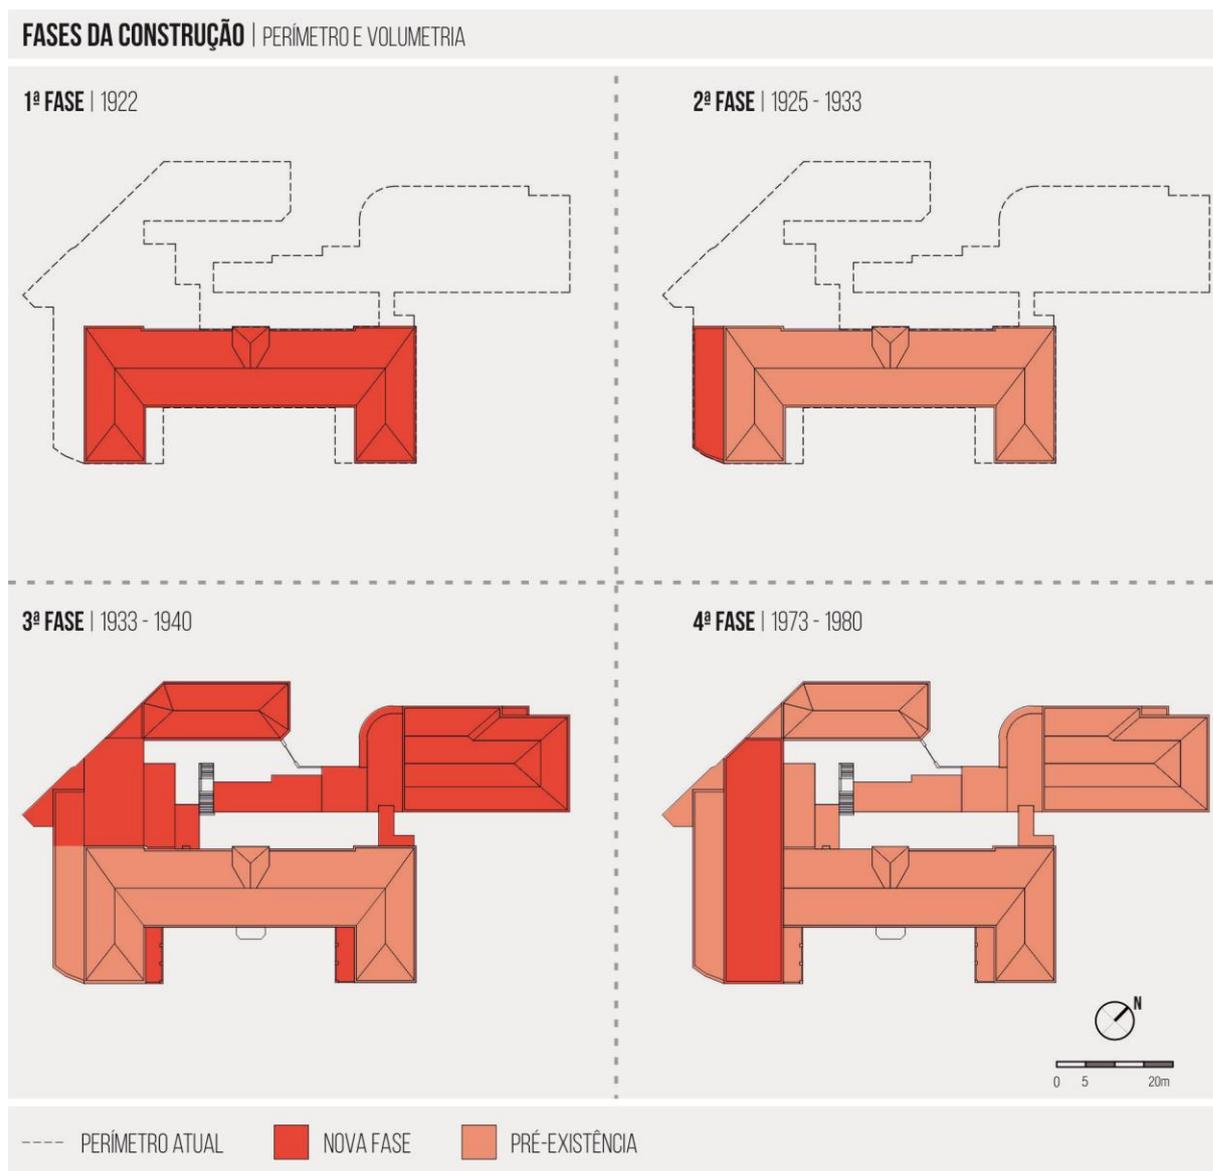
Fases da construção com alteração do perímetro e volume
